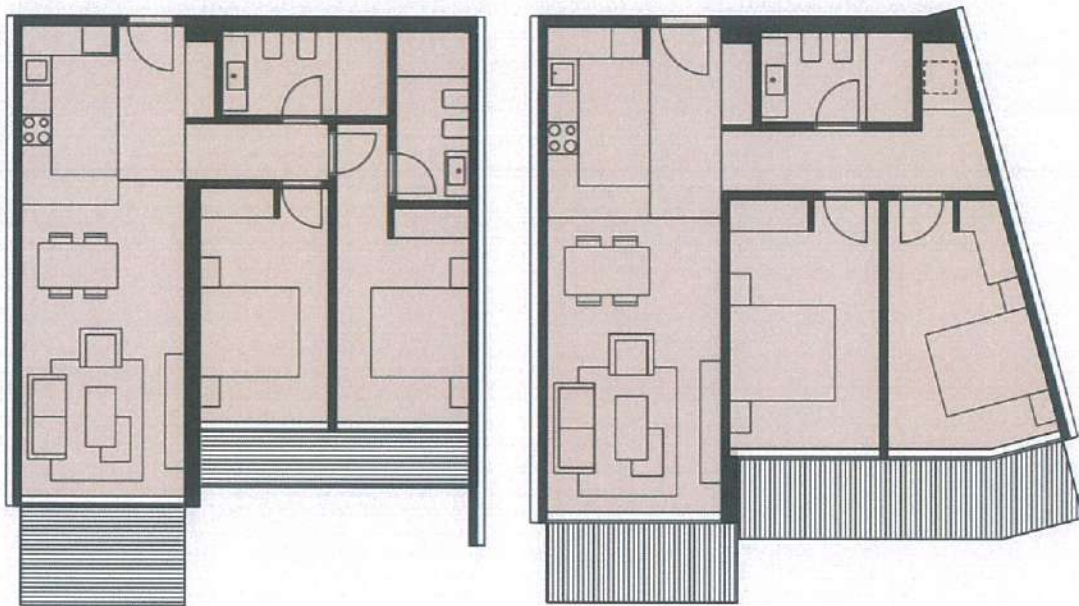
Planimetri e Apartamentit Tip 2+1 – Nënvariante
